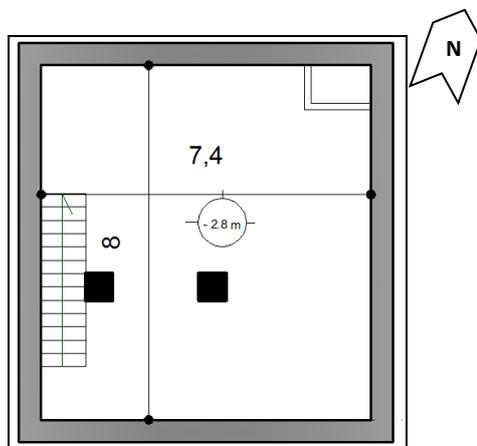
, l'emplacement des poteaux du sous-sol, source : Ep
